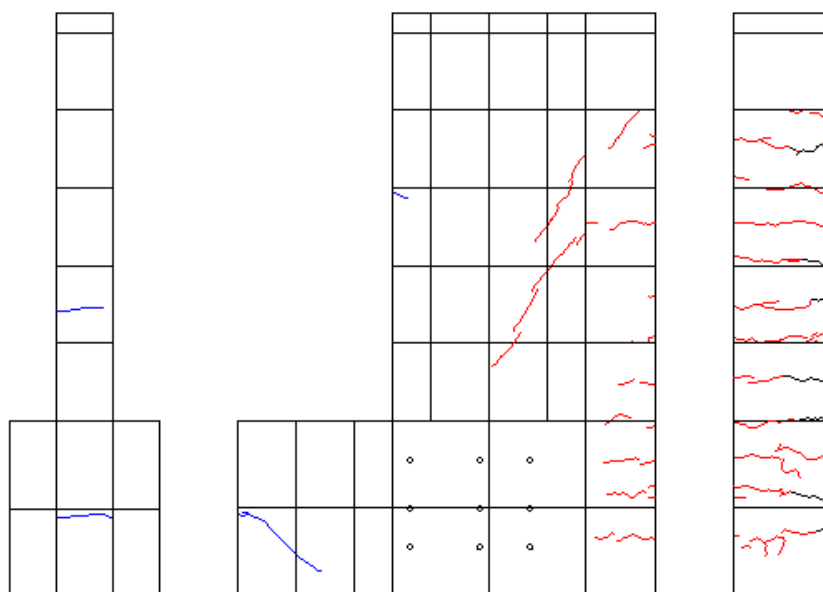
R=-1/400 ひび割れ図
